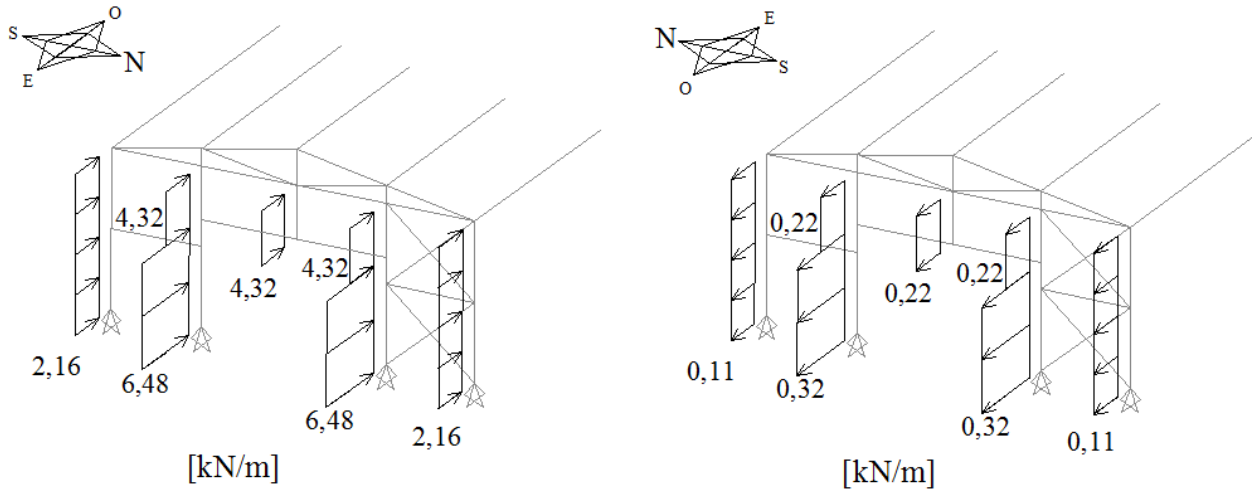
Vento W2 nas fachadas orientadas a Este e Oeste na situação 2 (RSA)
